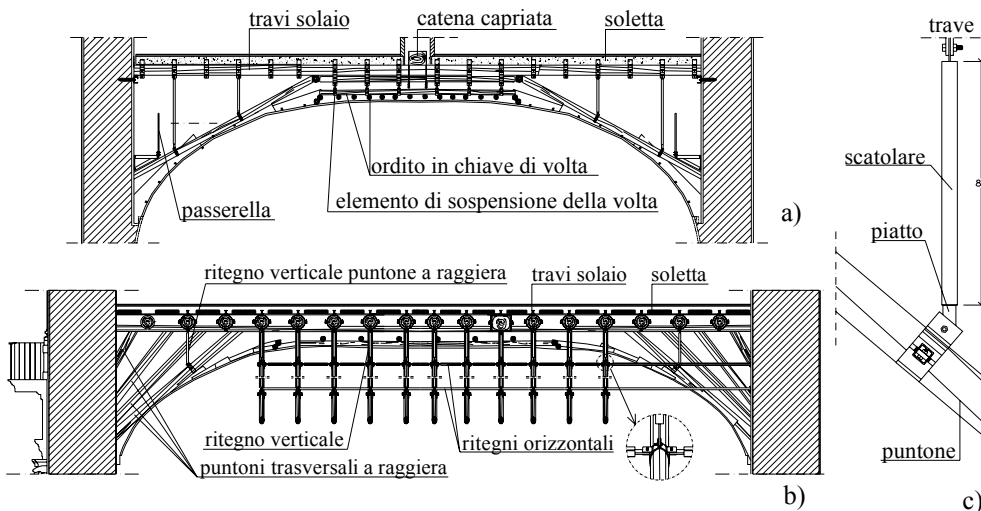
Posizionamento elementi di irrigidimento puntoni: a) Sezione longitudinale; b) Sezione trasversale; c) Particolare elemento singolo.
